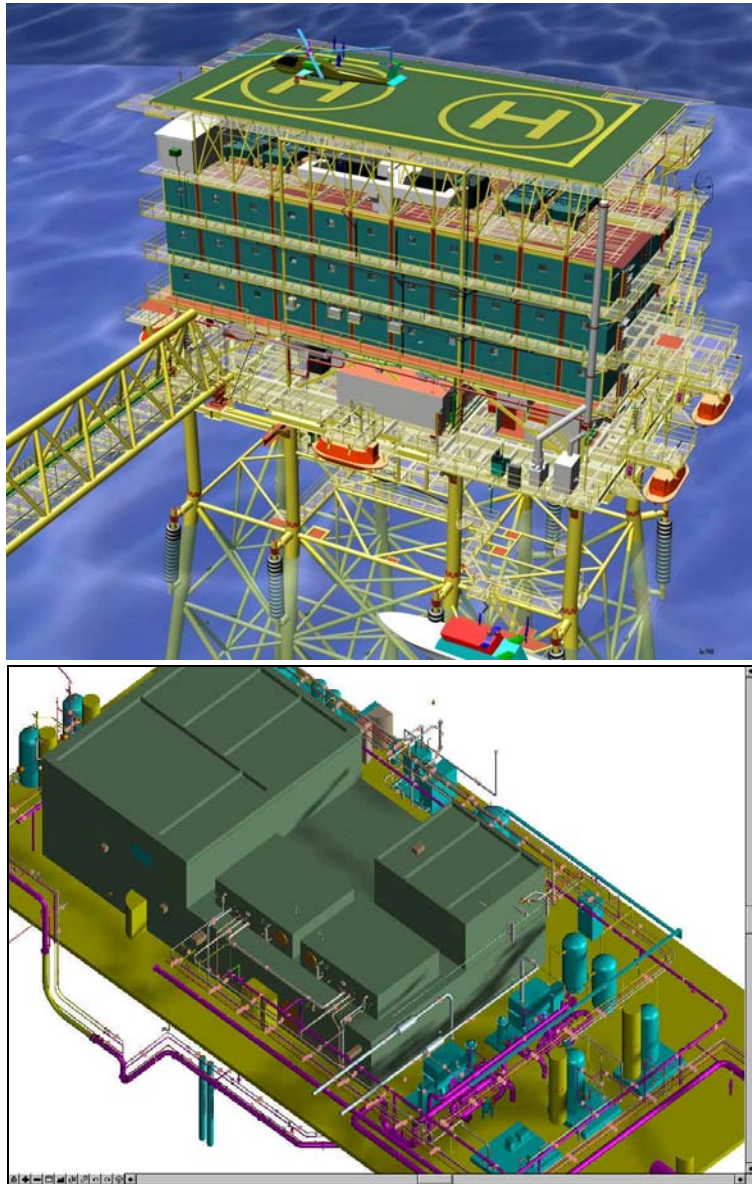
Muestra del CAD 3D para Diseño de Plantas.
